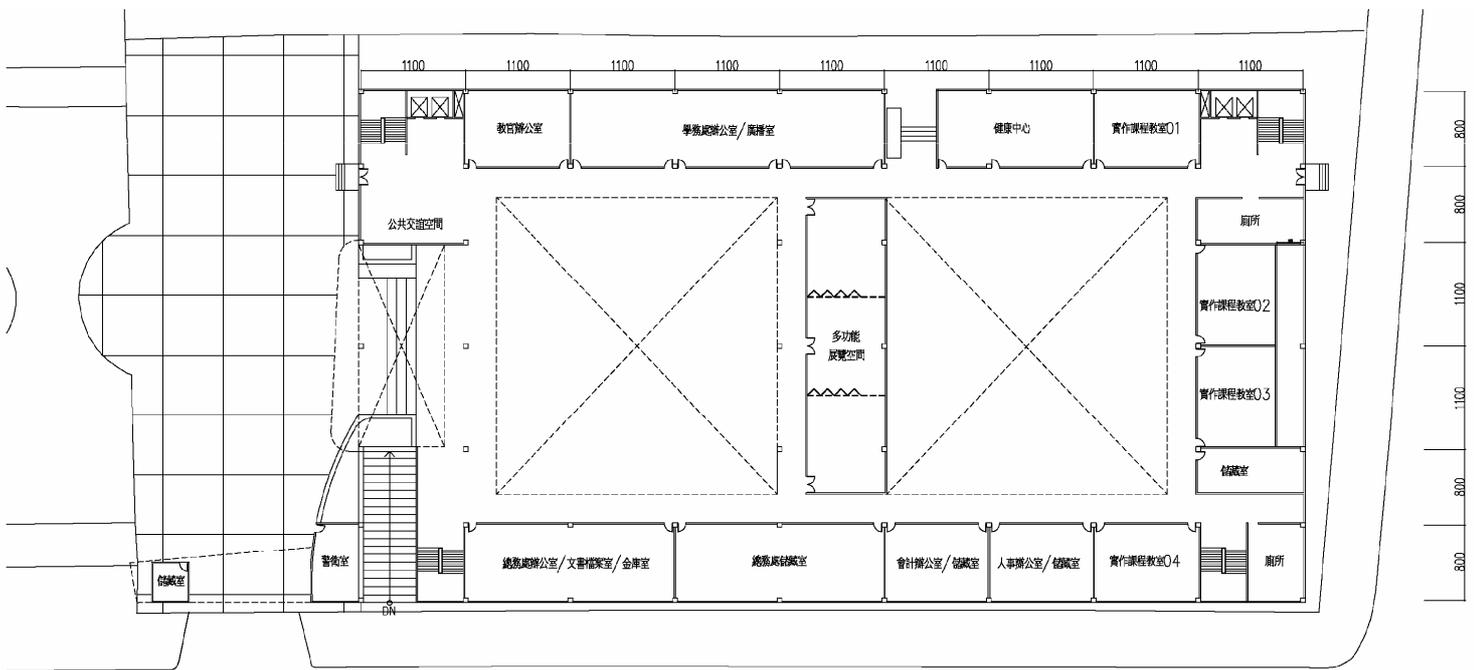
綜合教學大樓 B2 層平面圖（方案 A）
